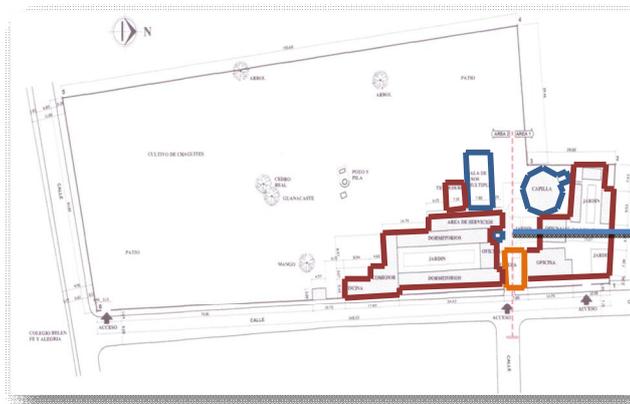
Planta de conjunto del Hogar Santa Lucía./ Fuente: Propia.
